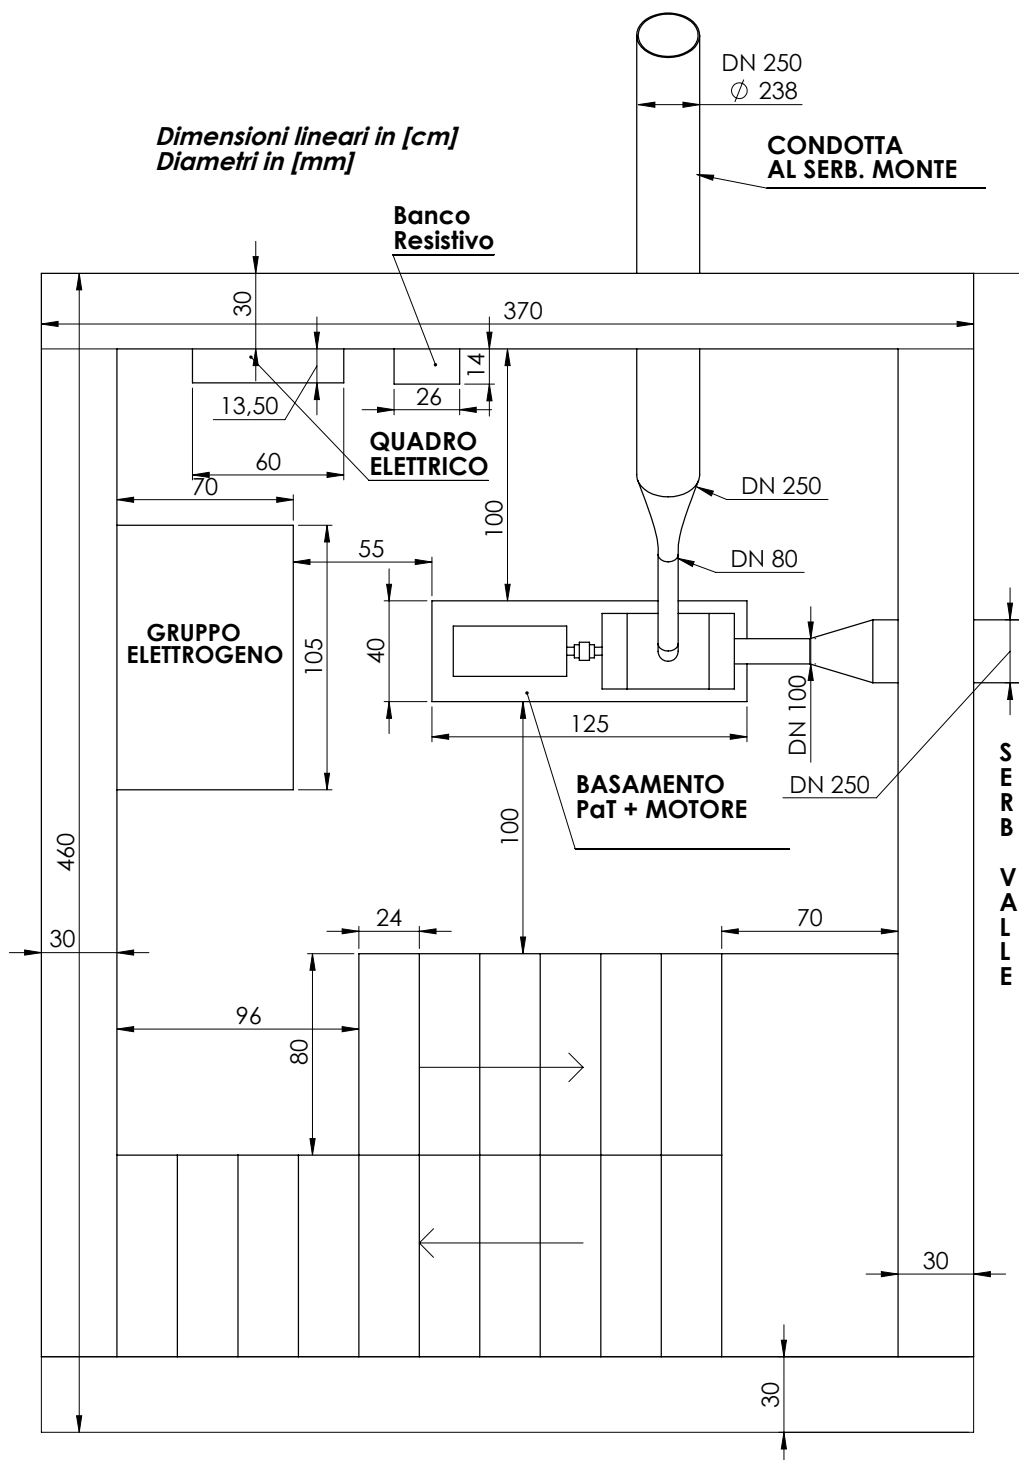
Vista dall'alto del locale tecnico, disposizione spaziale dei componenti installati all'interno.
